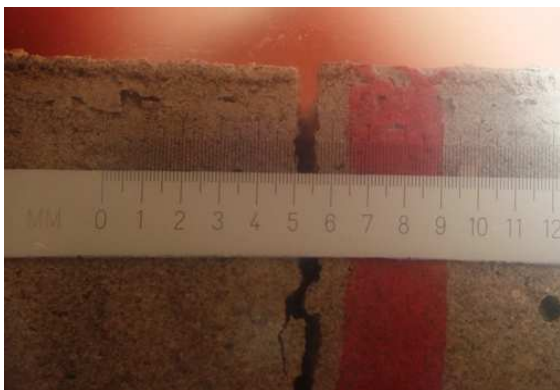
Abertura de fendas no apoio central da viga G1-a para a carga de 23 kN
